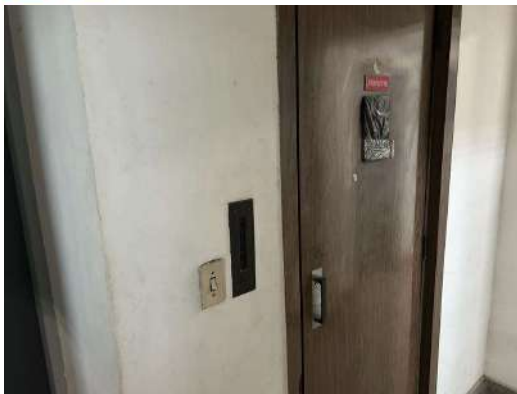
ELEVADORES 3 E 4 DO IBGE EQUADOR/RJ
